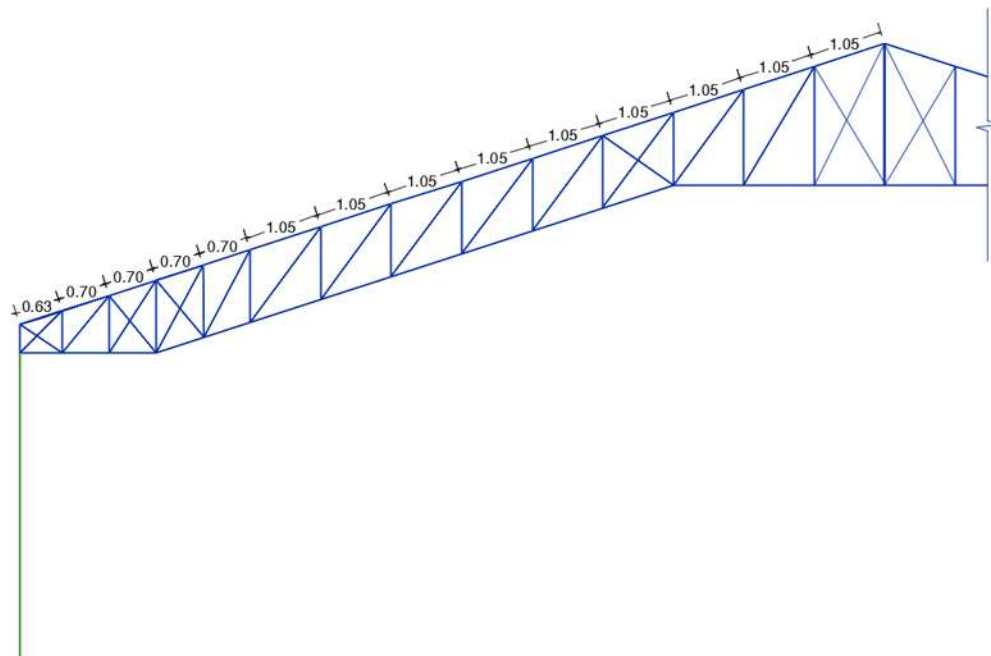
Separación entre apoyos de cubierta (metros)
